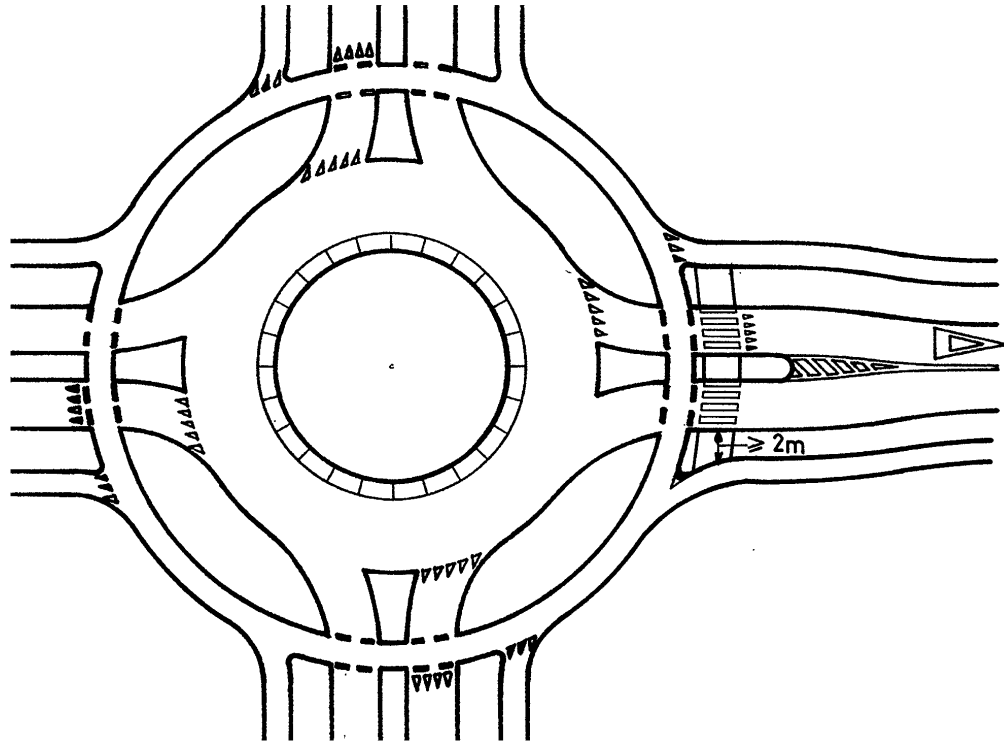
Voorzieningen van voetgangers op een rotonde met aanliggend fietspad
